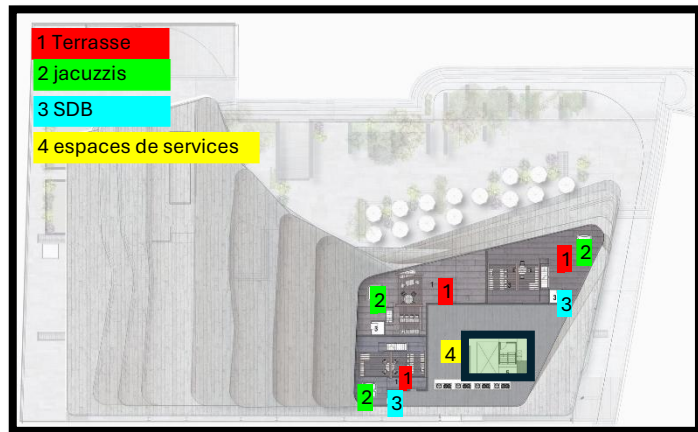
plan terrasse www.archdaily.com traite par les auteurs
